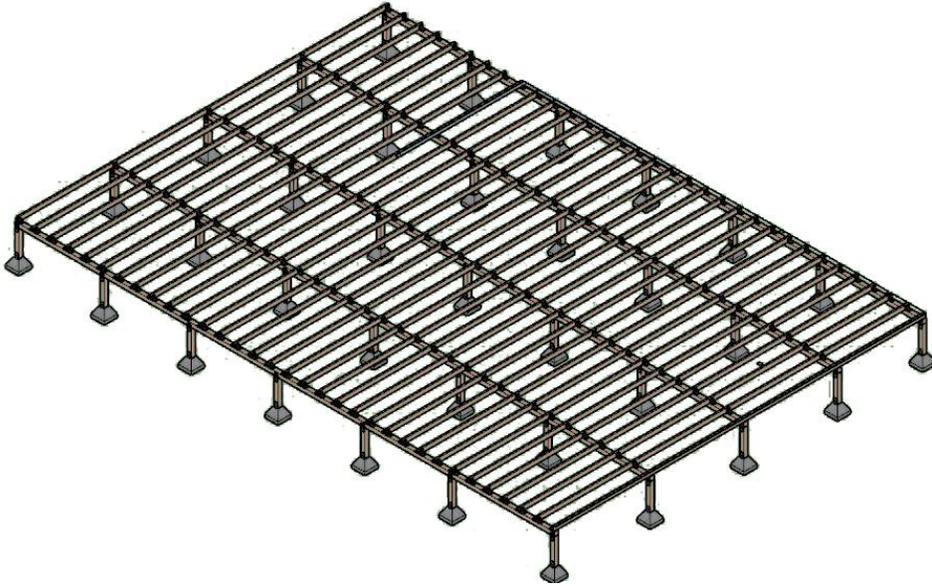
Estructura de cimentación y entrepiso. Elaboración del autor
